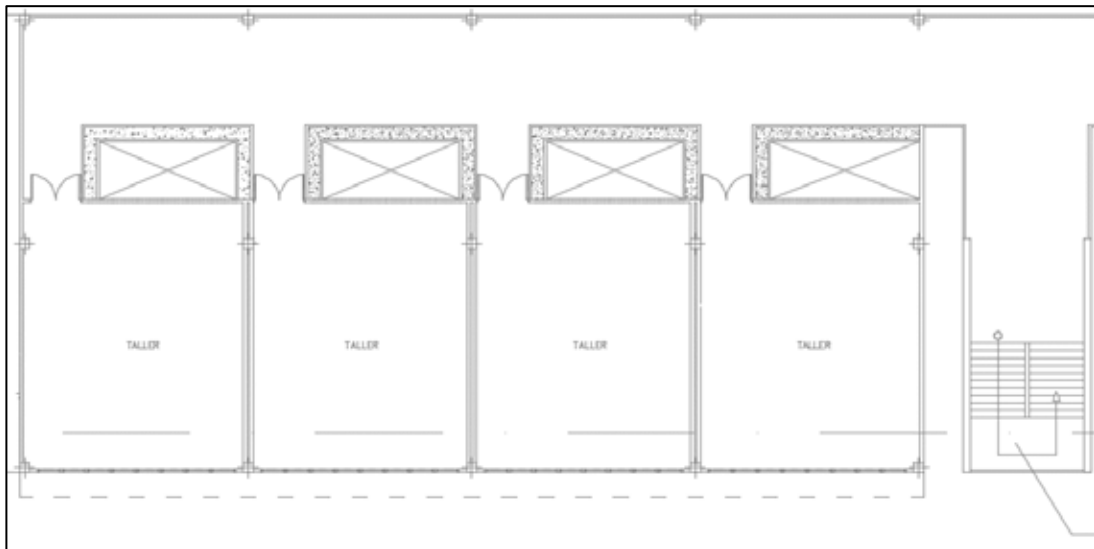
Planta Baja Módulo Artístico. Fuente: Propia autoría. (2018).
